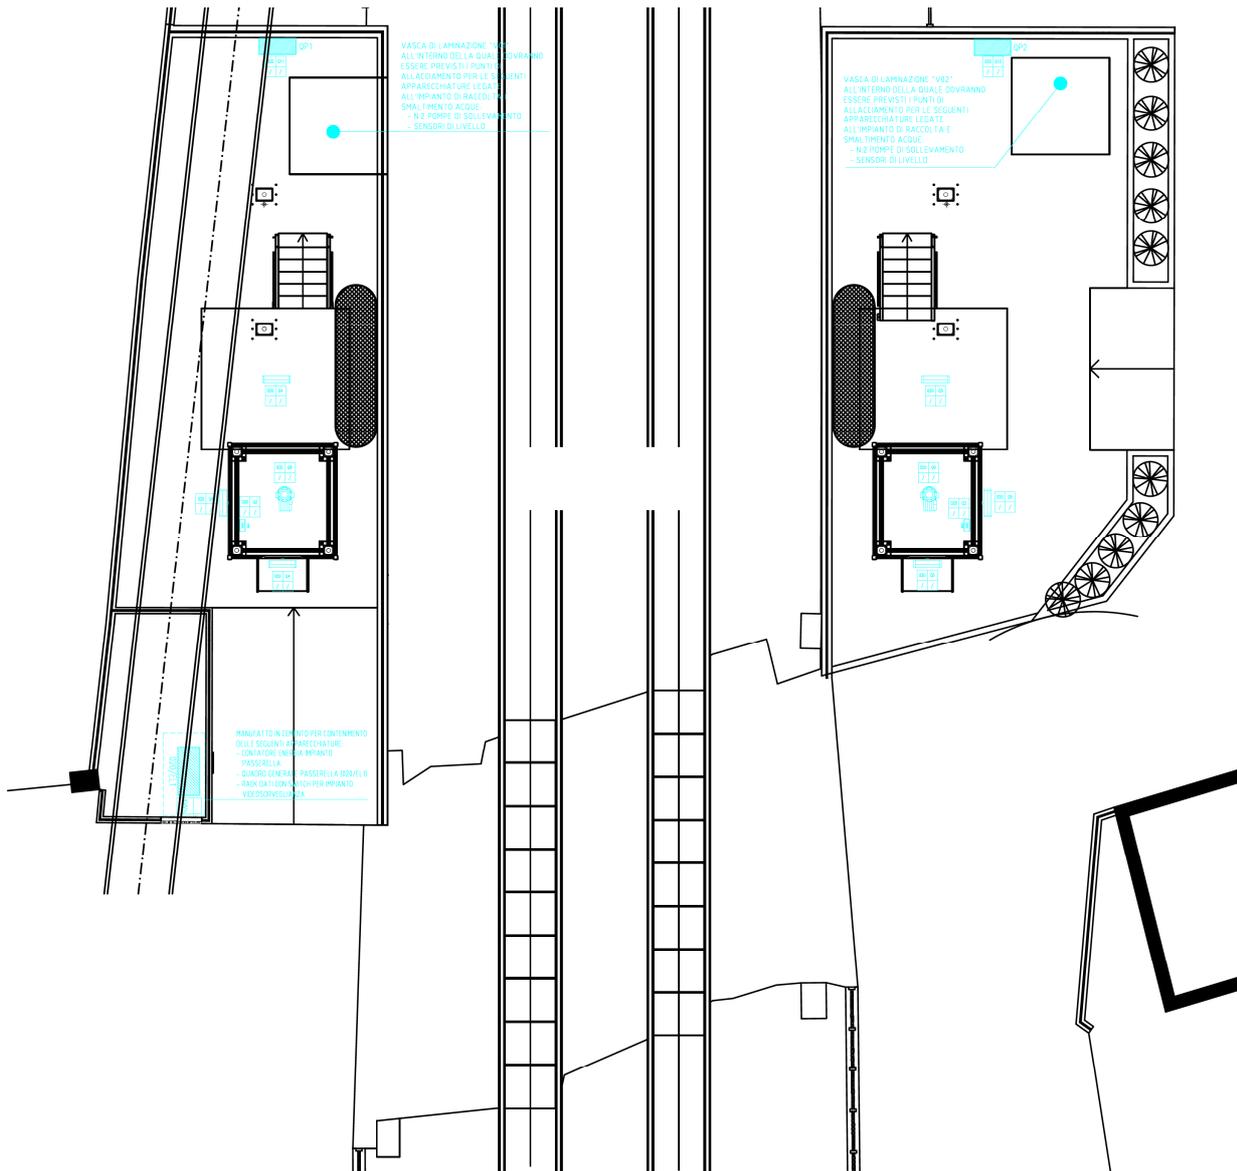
Estratto planimetria generale impianti elettrici al piano terra
